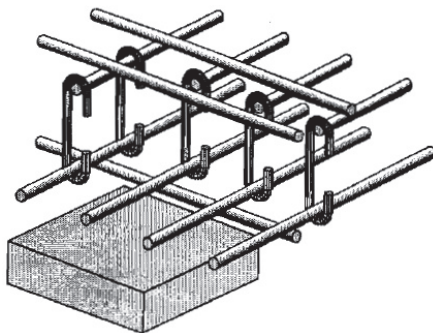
Armadura específica de punçoamento - *Single-leg stirrup* [25]
